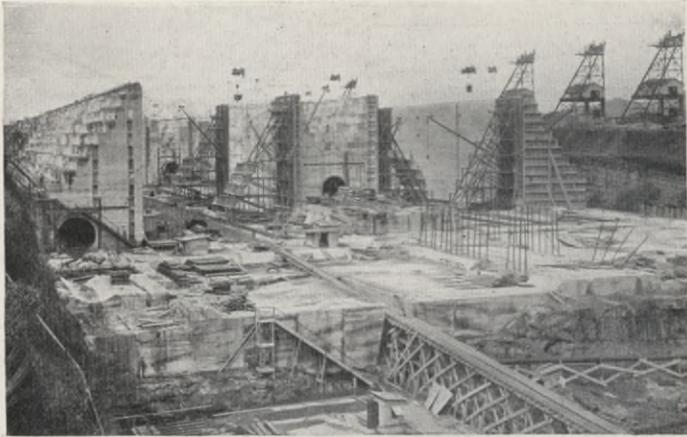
Beförderung der fertigen Betonmasse durch Drahtseilbahnen.
